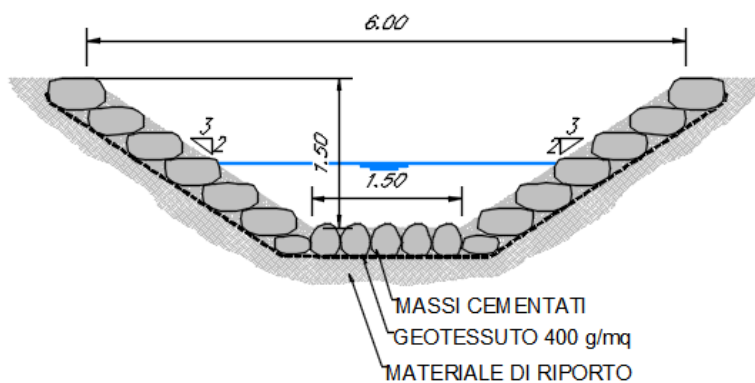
Corso d'acqua IN04_ Sezione tipo sistemazione
